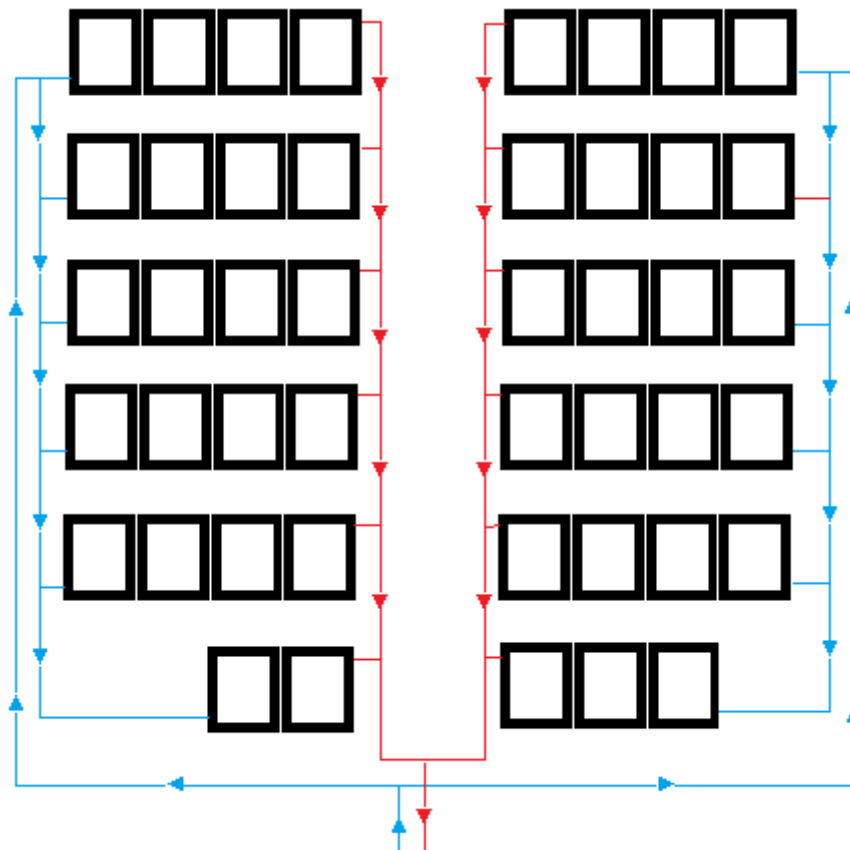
Disposición captadores solares en la cubierta del edificio.
